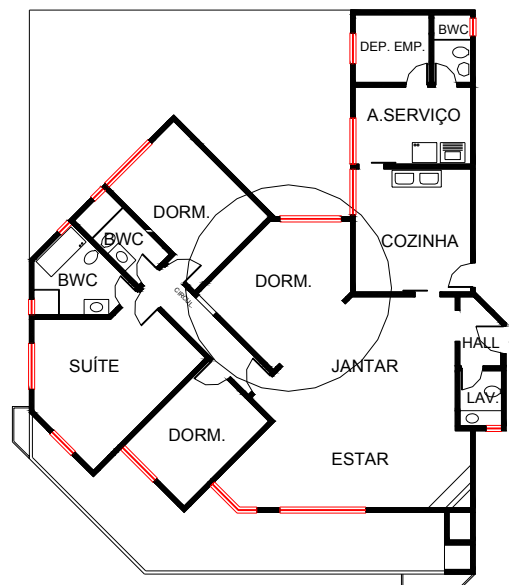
Planta Baixa do apartamento 301 - Estudo de caso C.
